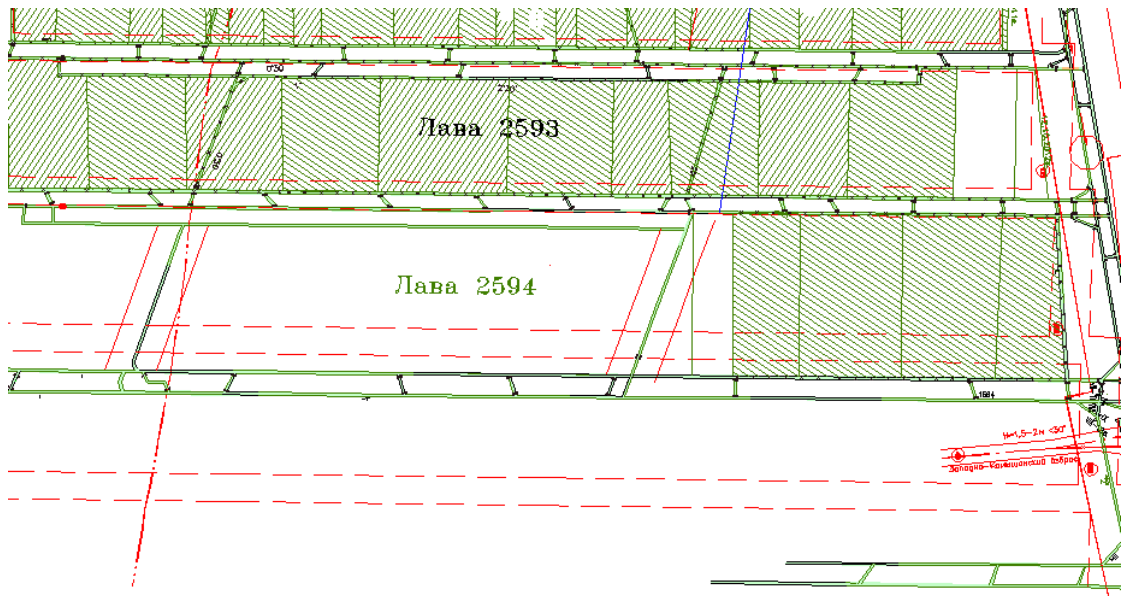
Выкопировка из плана горных работ по пласту Поленовский (красным цветом обозначены зоны ПГД)
